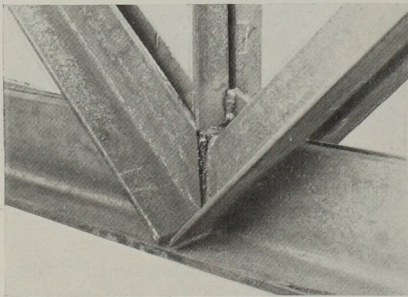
Ungünstig geschweißter Knotenpunkt
